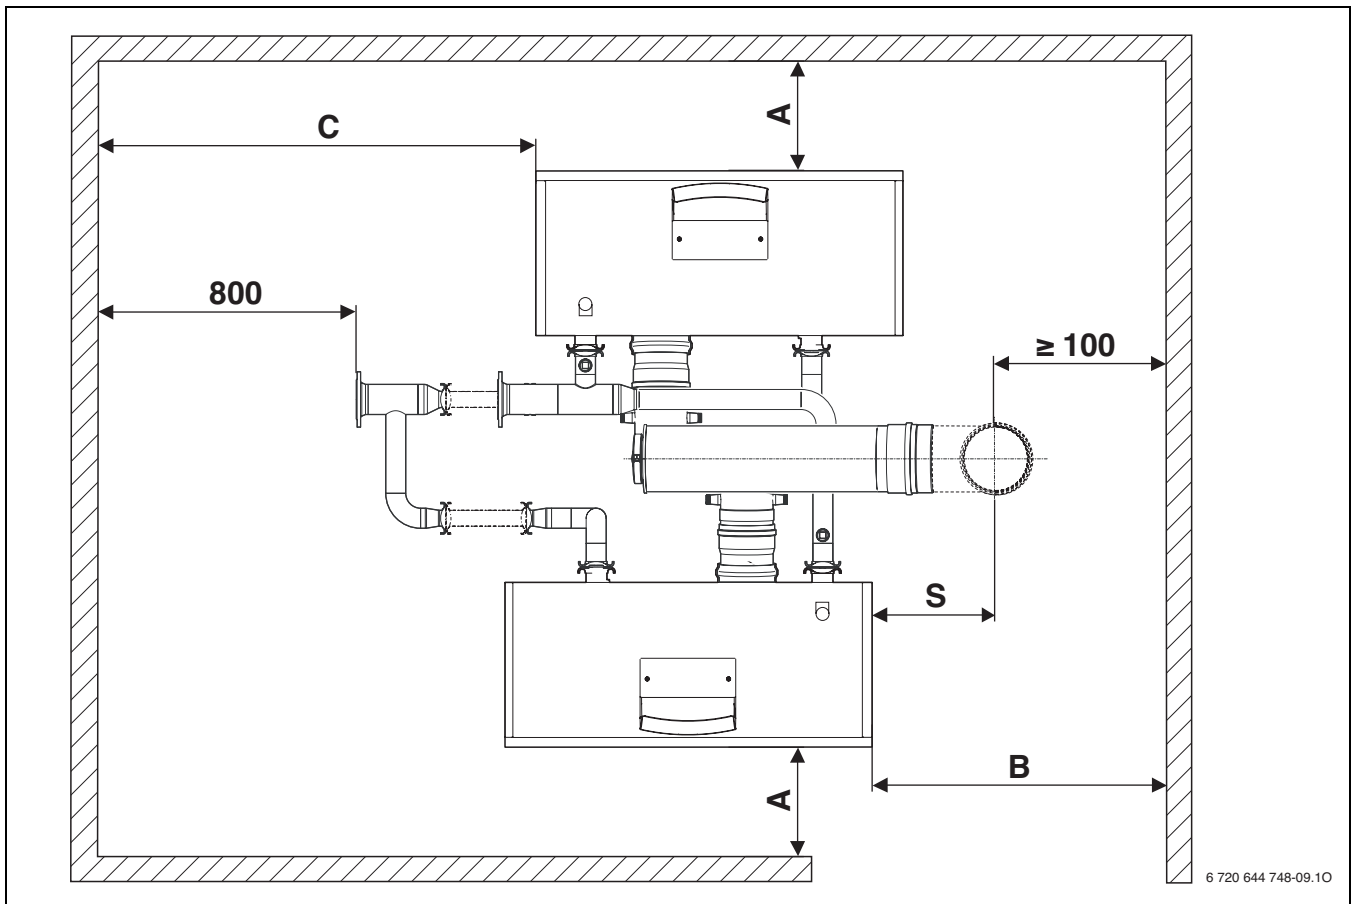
Aufstellmaße Suprapur – Werkseitige 2-Kessel-Kaskade (Maße in mm)
